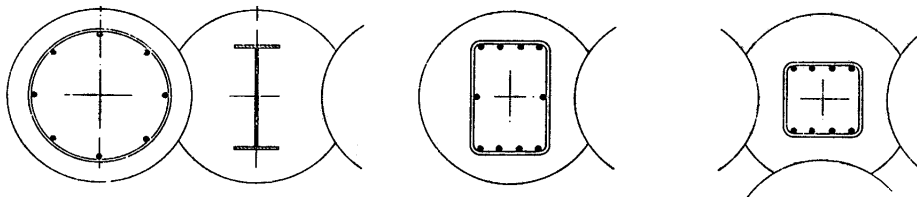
Diversas opciones para acero de refuerzo en pilas secantes
